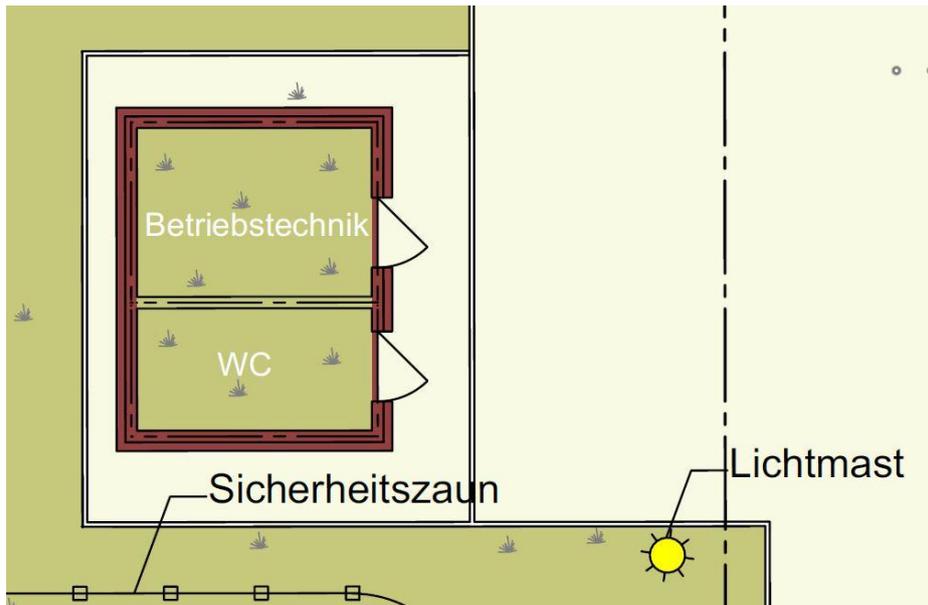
Betriebstechnikgebäude, Grundriss
